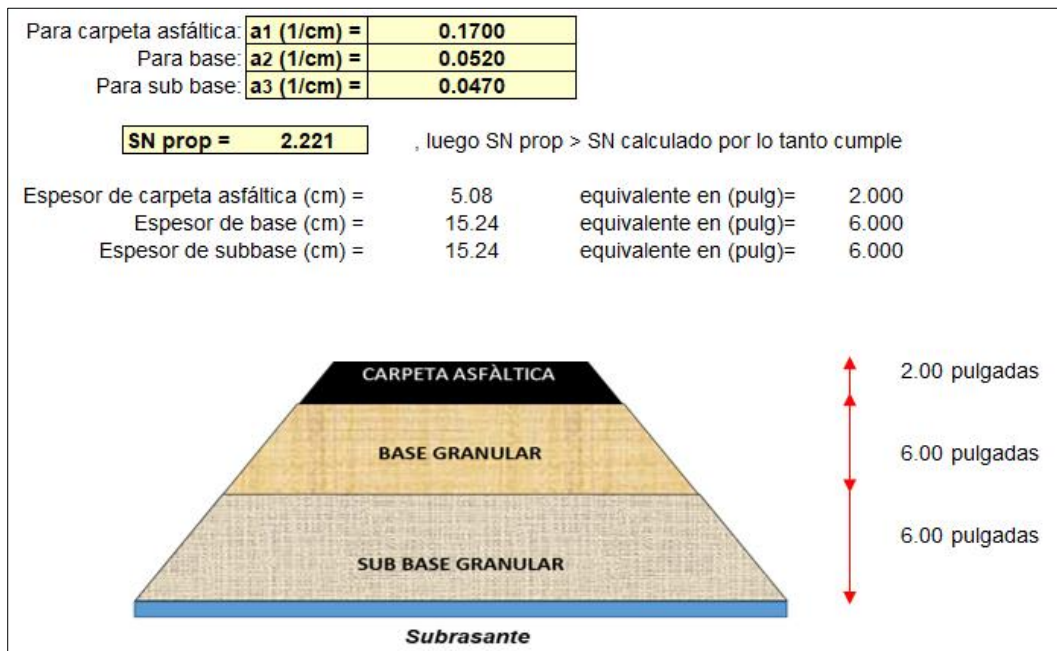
Detalle de la sección de estructura de pavimento flexible.
